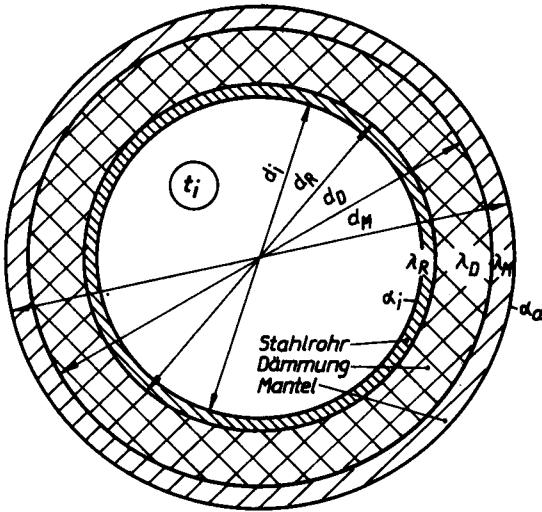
7 Querschnitt eines wärmeisolierten Rohrs
